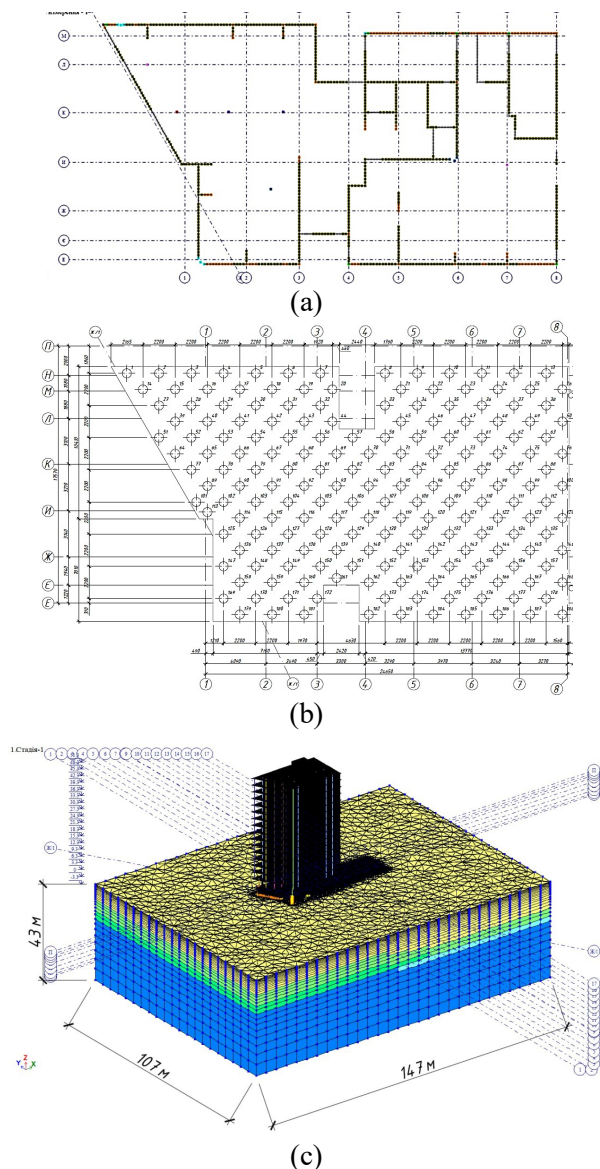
Задача №1: (а) – план вертикальних несучих елементів; (б) – план фундаментів; (с) – СЕ-модель.
